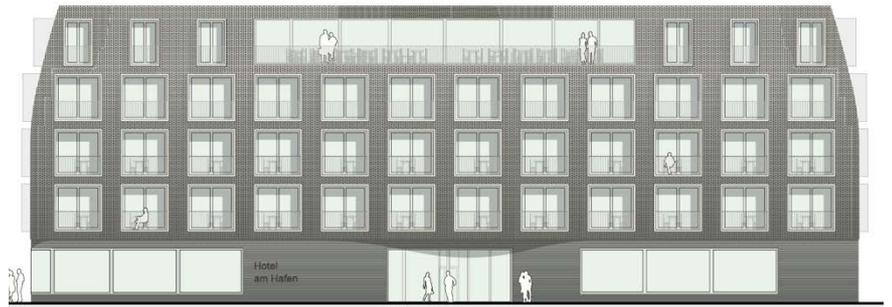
Fassadenansicht Dienstleister (original 1:200)
